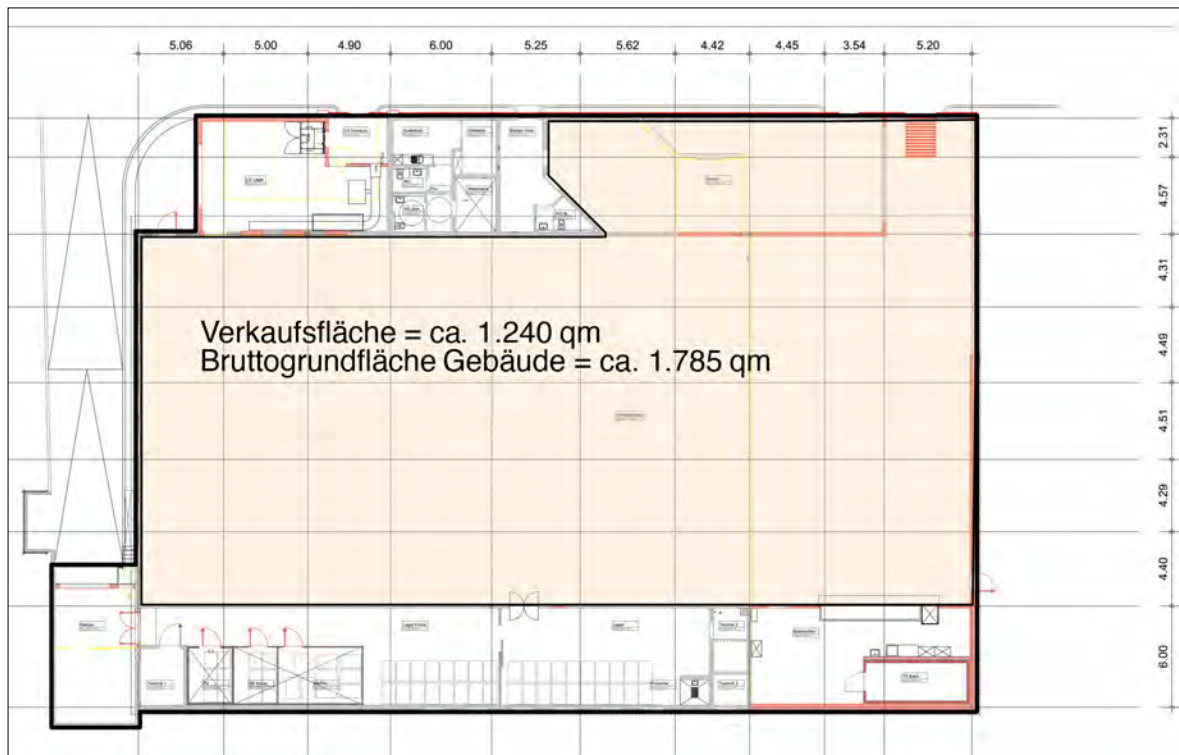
Grundriss Nahversorgungsmarkt (Quelle: Architekturbüro Krauter+Kling, Berlin)
